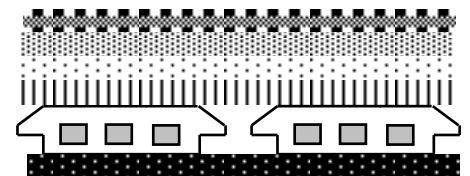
Coupe de plancher étage courant -corps creux-
